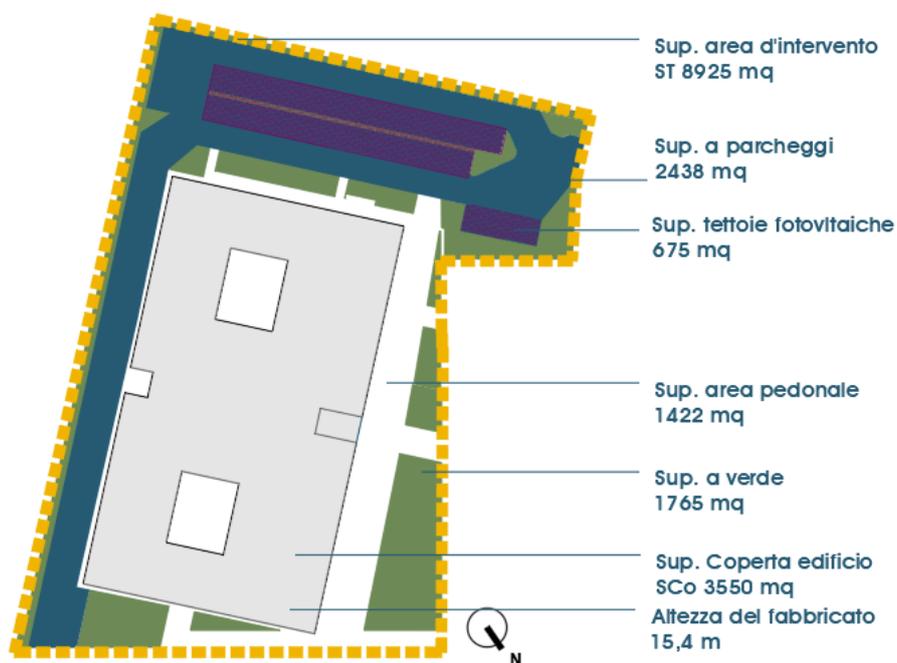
Stralcio elaborato grafico PF.PR.02b Planimetria generale
